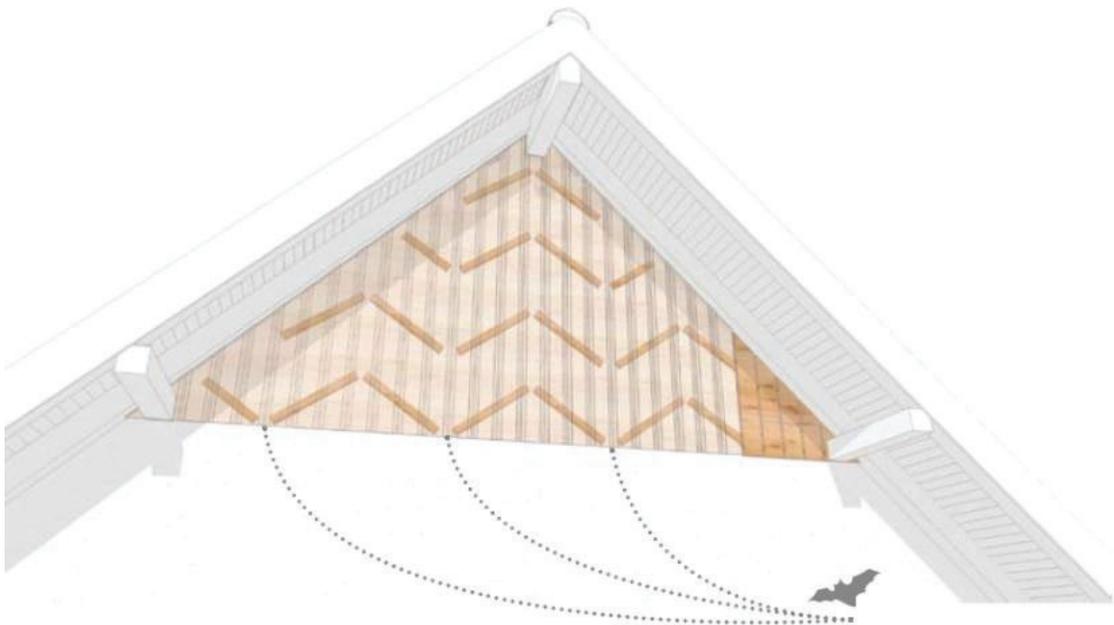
Beispielhafte Darstellung einer Holzverkleidung mit Unterkonstruktion aus Holzlatte und Einschlußöffnungen (aus Schmidt 2014)
